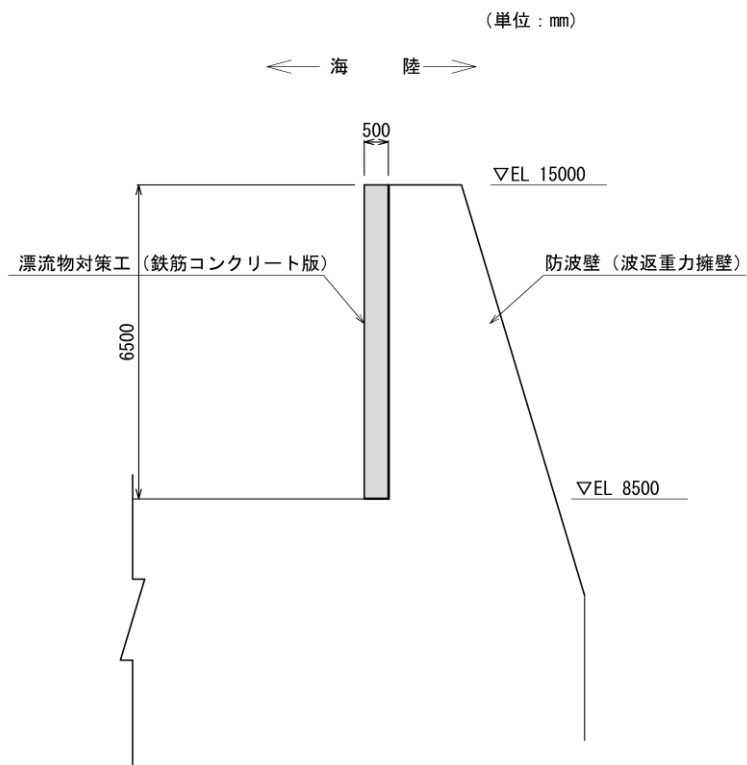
漂流物対策工⑥の構造概要図 (断面図)
